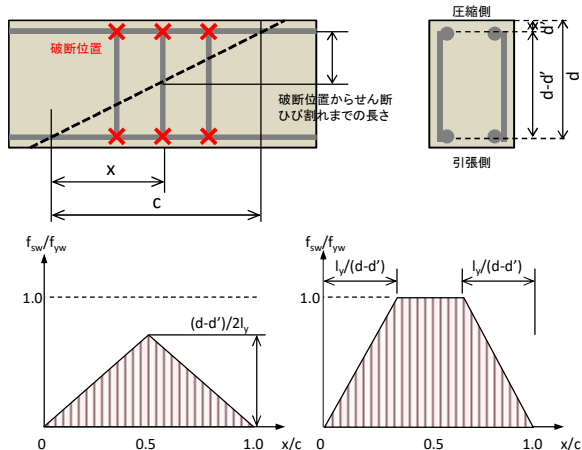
斜めひび割れ内の破断したせん断補強鉄筋応力
